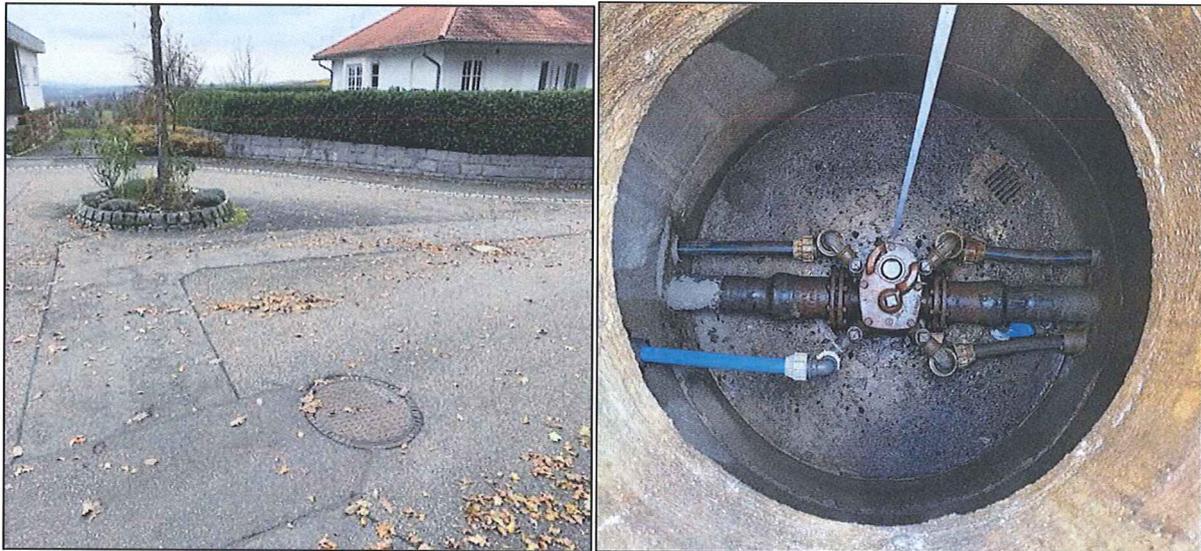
Wendeplatte Langhansstraße auf Höhe Gebäude 32/34 mit MW-Kanal- und Wasserleitungsschacht
